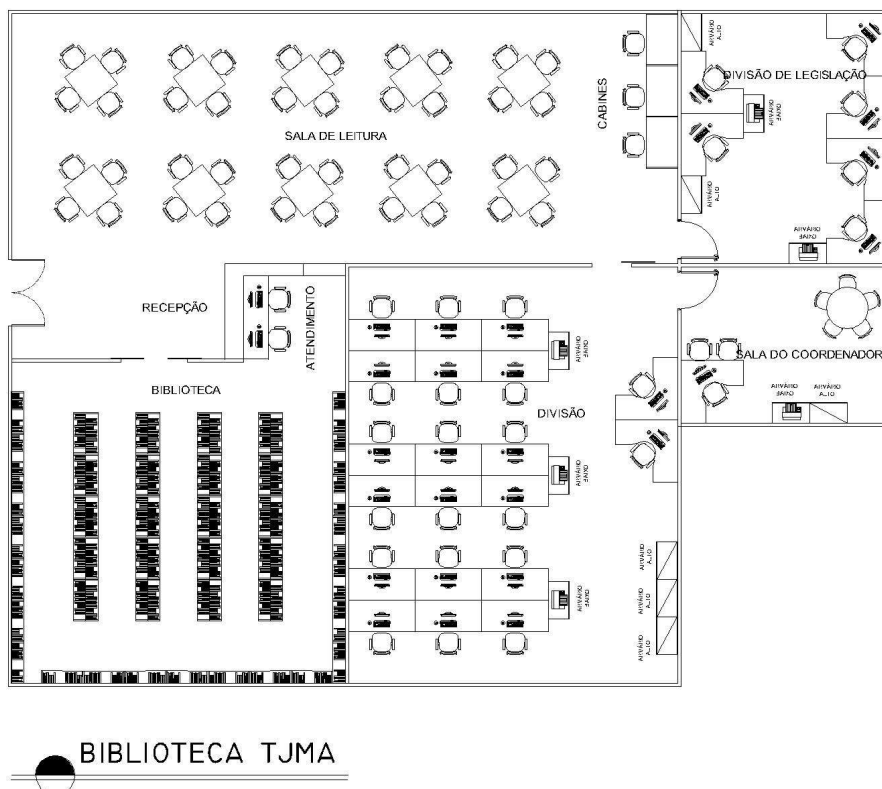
Croqui Layout esquemático da Coordenadoria de Gestão da Memória e Biblioteca
